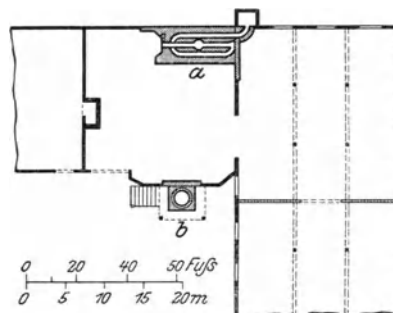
Plan der Klettschen Maschinenfabrik 1841.
